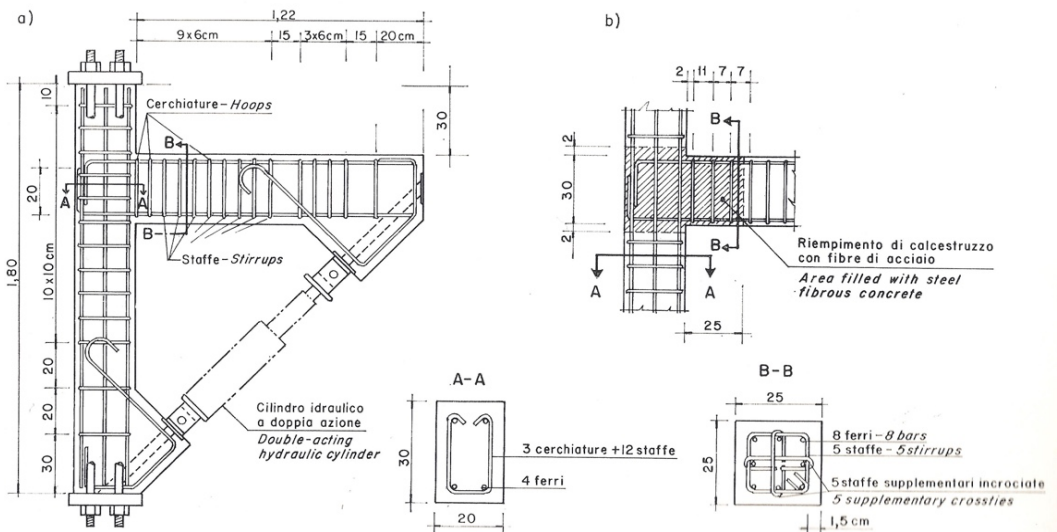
Da “Cemento armato e azione sismica”, Aitec 1981
